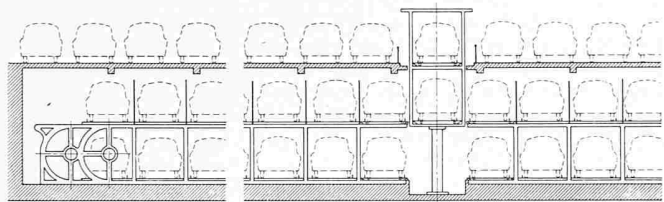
Konstruktionstyp für einstöckigen Unterflurbau
